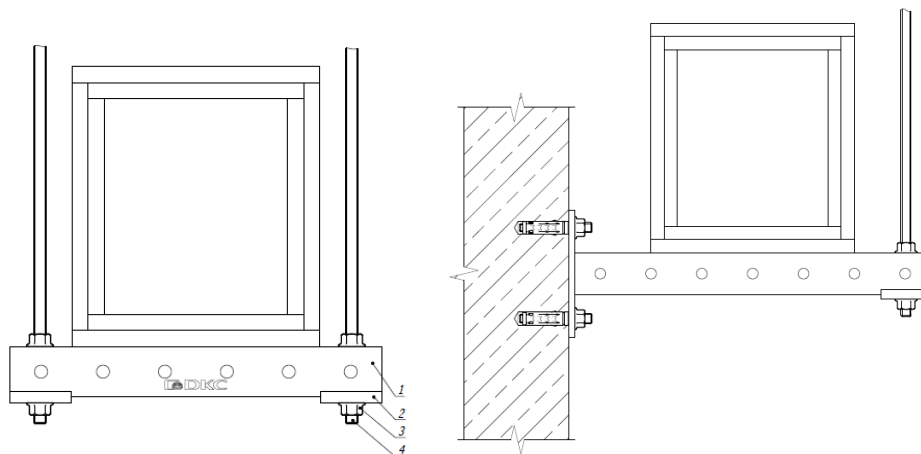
Крепление короба с четырьмя стенками к несущей поверхности
